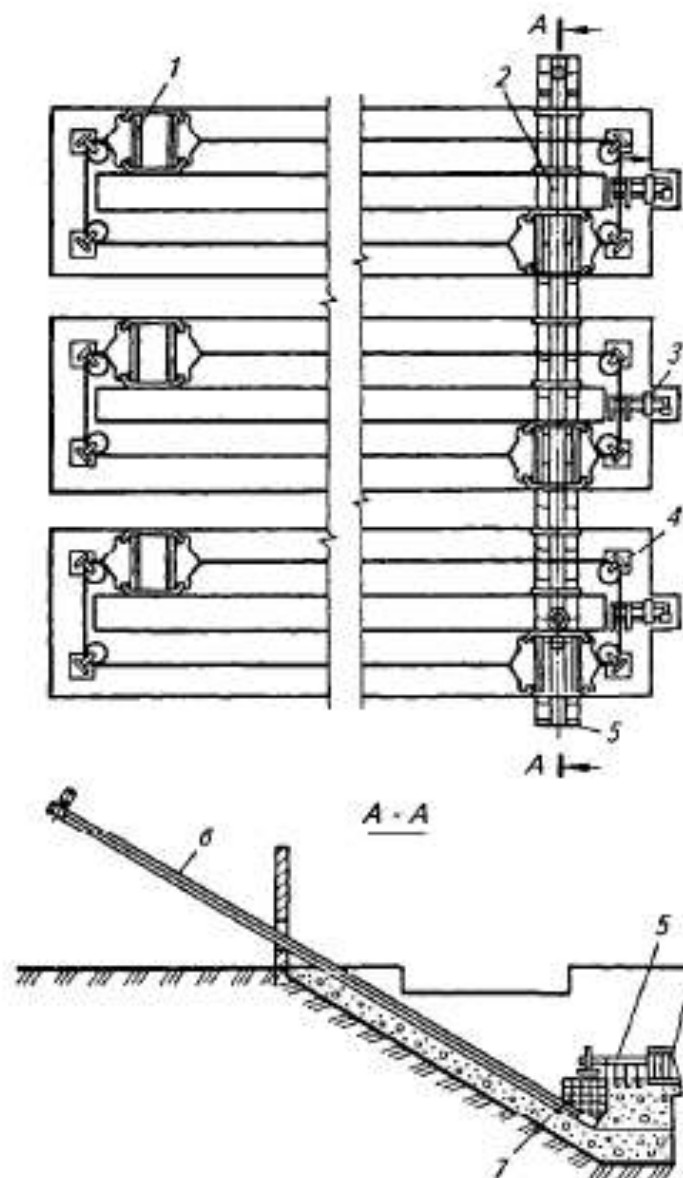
Система уборки навоза в крольчатнике: 1 – скреперная установка НСУ-1; 2, 5 – скребковый горизонтальный транспортер ТСН-3,0 Б; 3 – приводная станция; 4 – поворотный блок; 6 – наклонная часть транспортера ТСН-3,0 Б; 7 – решетка для стока жидкой фракции навоза
